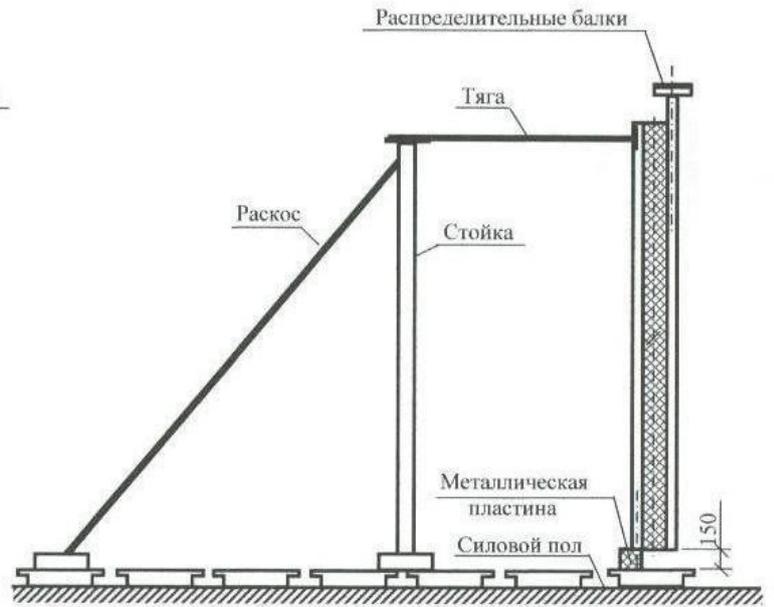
Закрепление панели от опрокидывания в ходе испытаний
